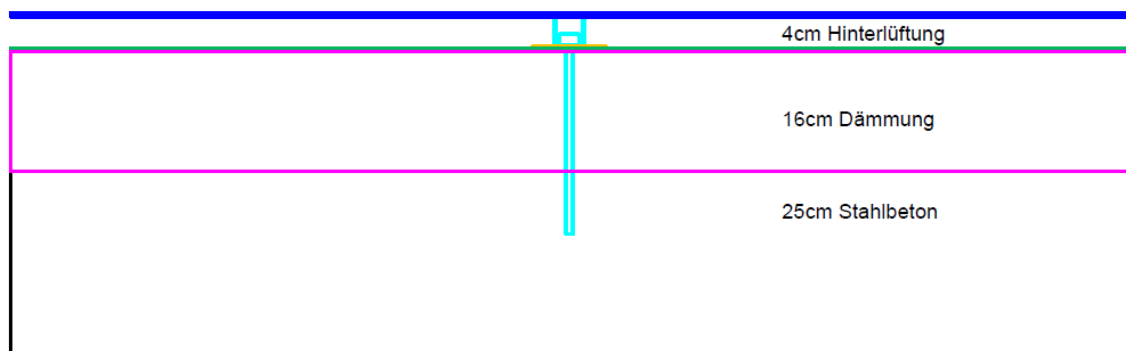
Diefenbachgasse – Detail der Unterkonstruktion, Abbildung um 90° gedreht
